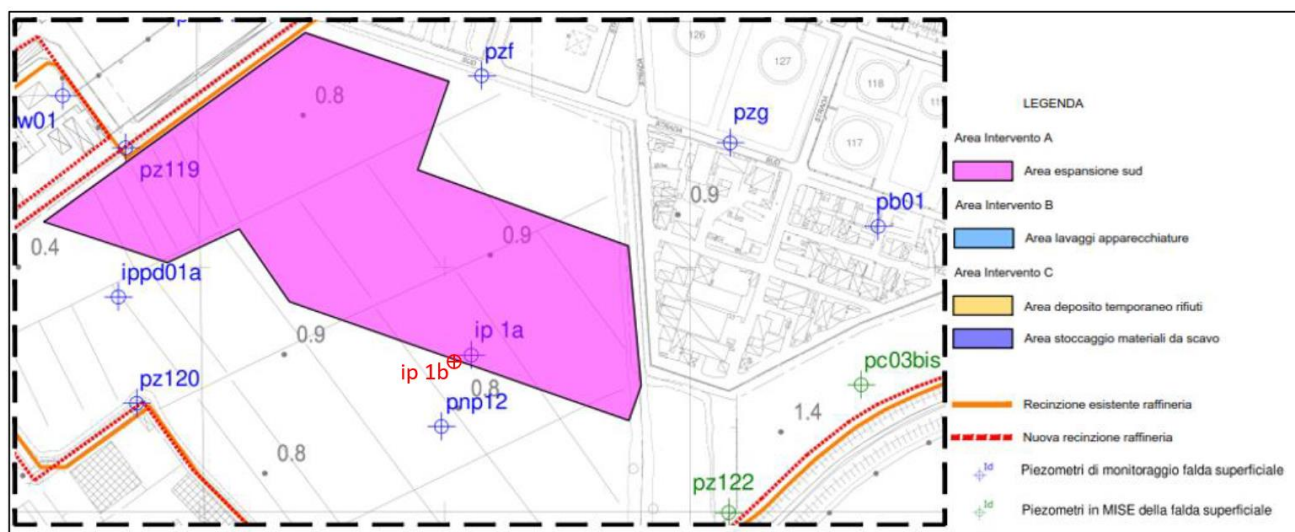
ubicazione dei piezometri potenzialmente interessati dalle operazioni previste nelle aree oggetto di intervento A – Espansione Zona Sud
